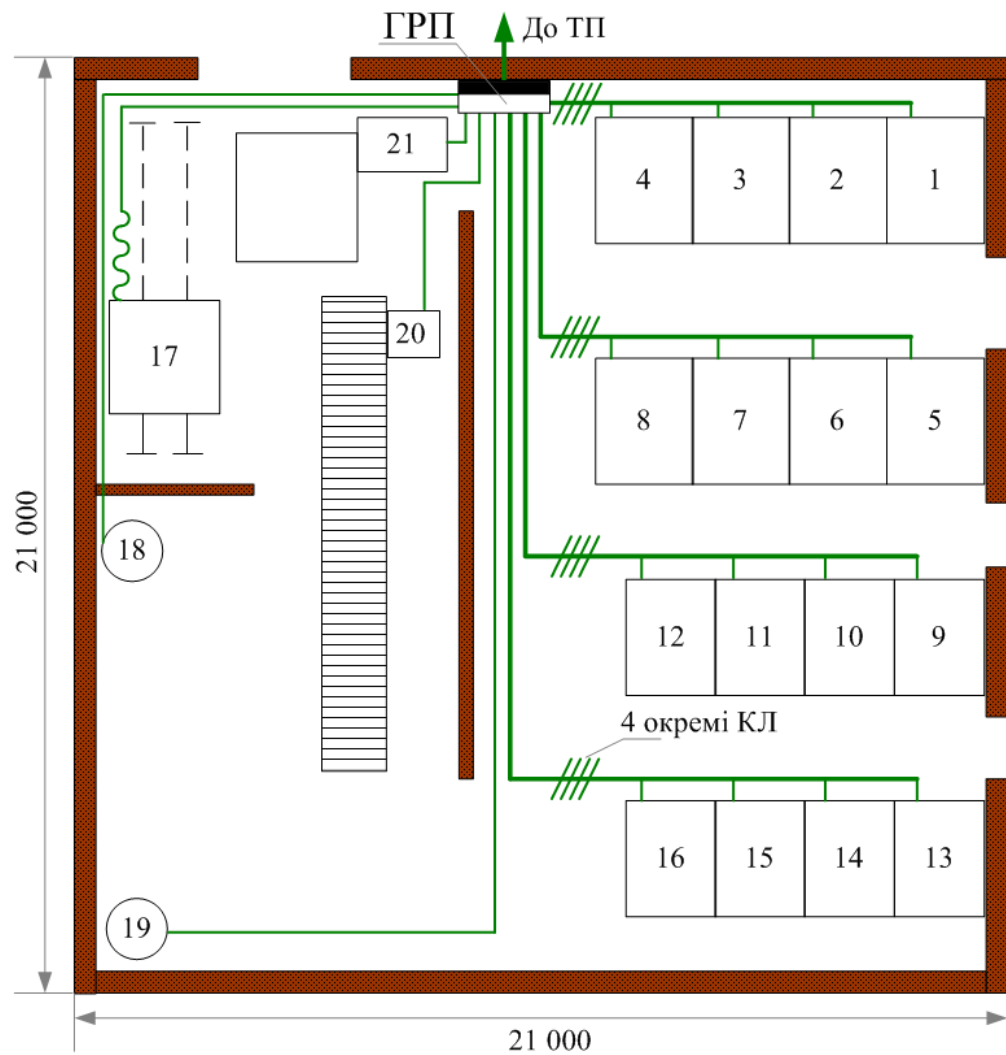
План постачання відвантажувального відділу (№6 на генплані)
